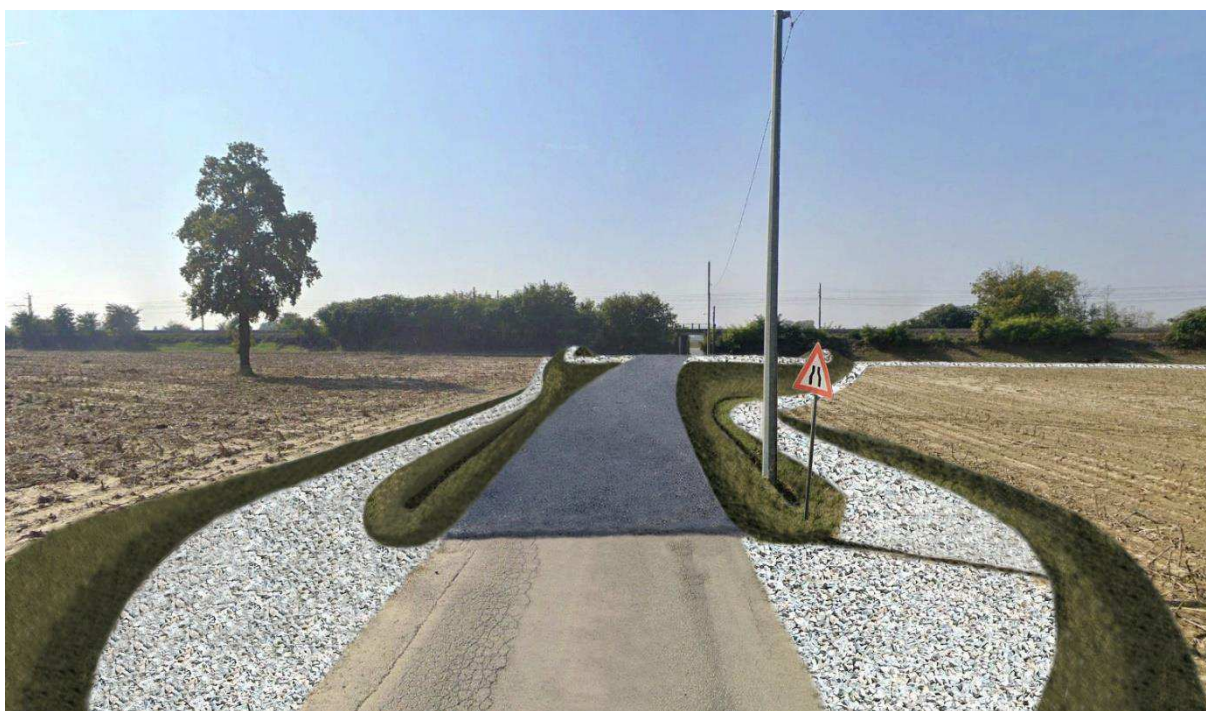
Fornice 2 – Situazione post operam - fotoinserimento rilevato stradale e coronella arginale in progetto
